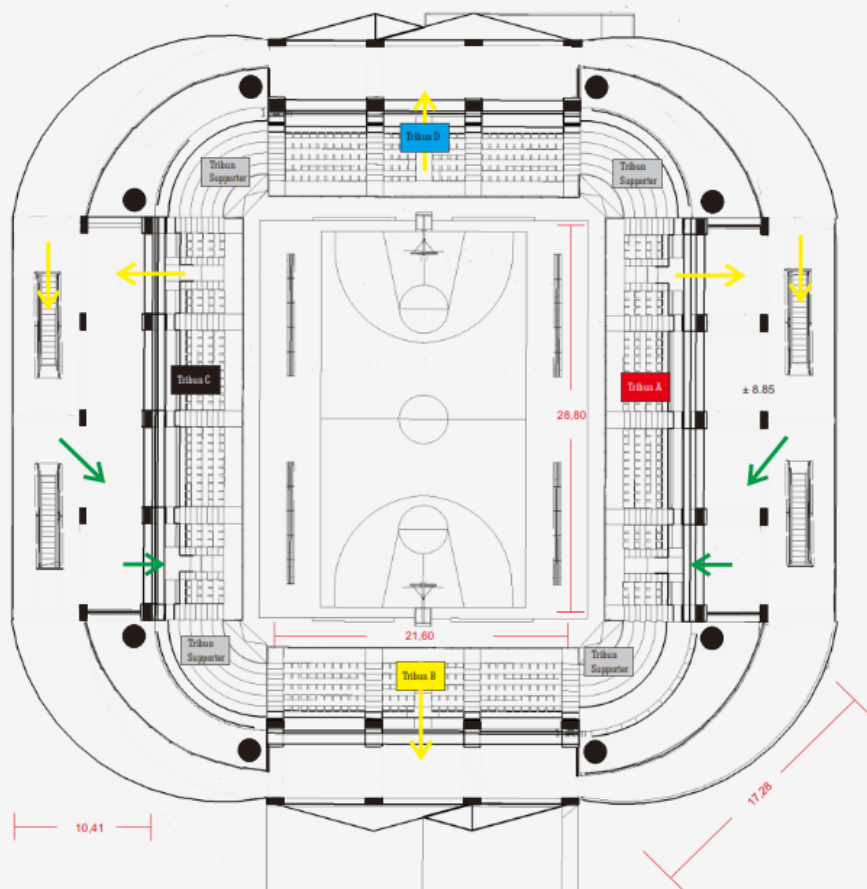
Denah lantai 1 1:200 (dokumen pribadi)
